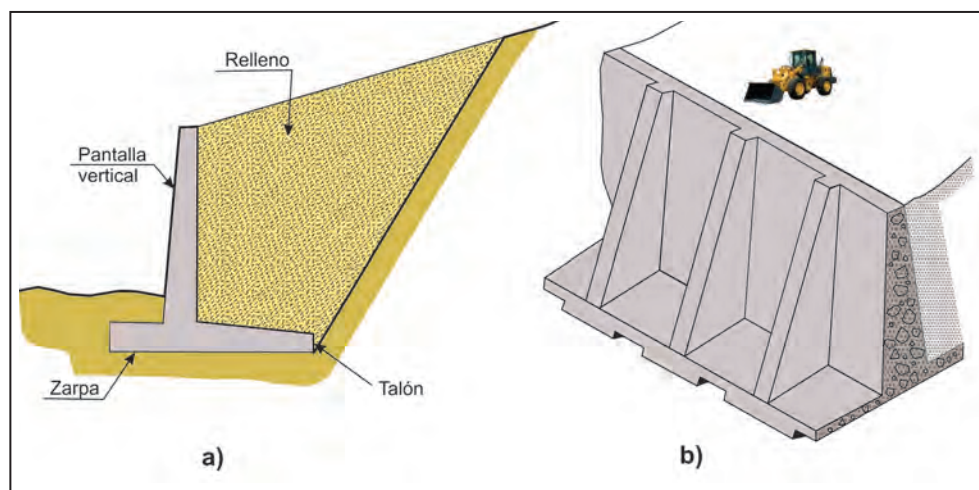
Muros aligerados: a) muro en L, b) muro con contrafuertes en el intradós (Jiménez, 1976).
